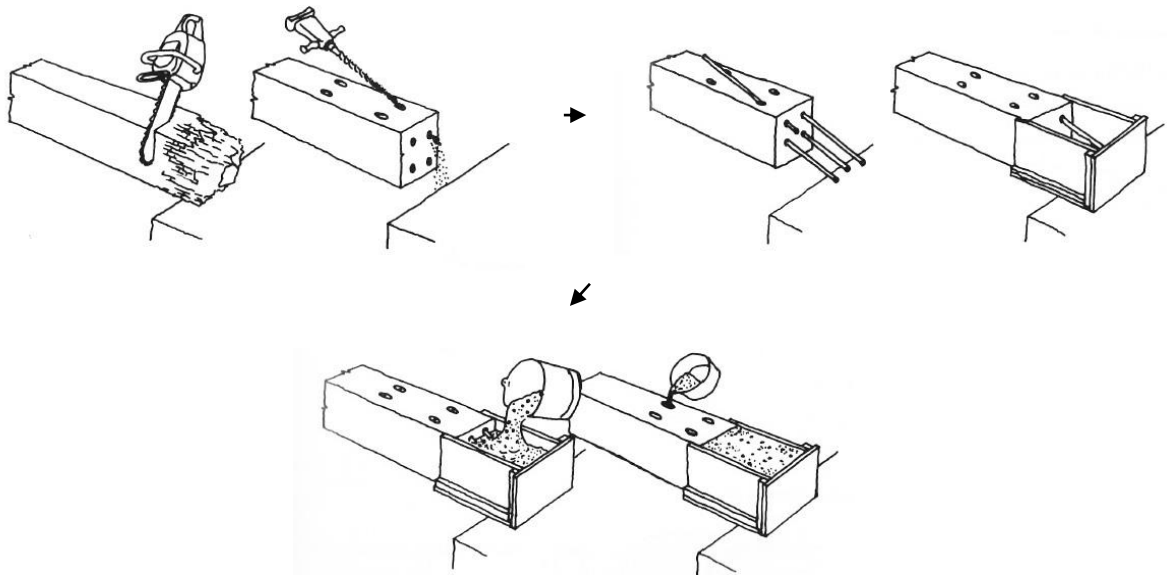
Sequência operativa para consolidação de apoio de viga com argamassa epóxi reforçada (Arriaga, et al., 2002)
